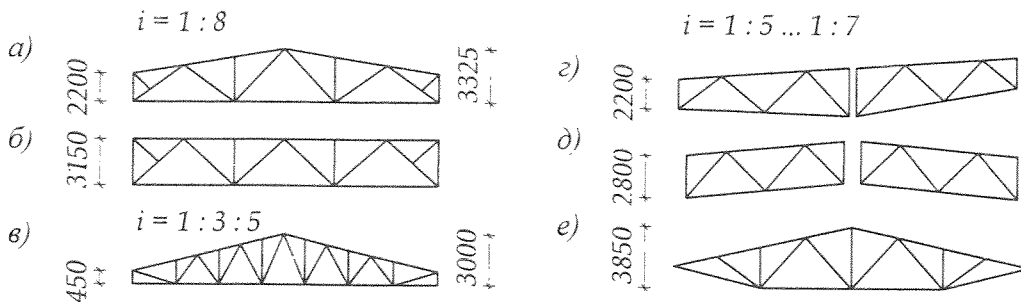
Примеры унифицированных схем стальных ферм промышленных зданий: а — трапециевидная двухскатная; б — с параллельными поясами под плоскую кровлю; в — треугольная; г — трапециевидная односкатная; д — с параллельными поясами под двухскатную кровлю; е — треугольная под крутую кровлю
